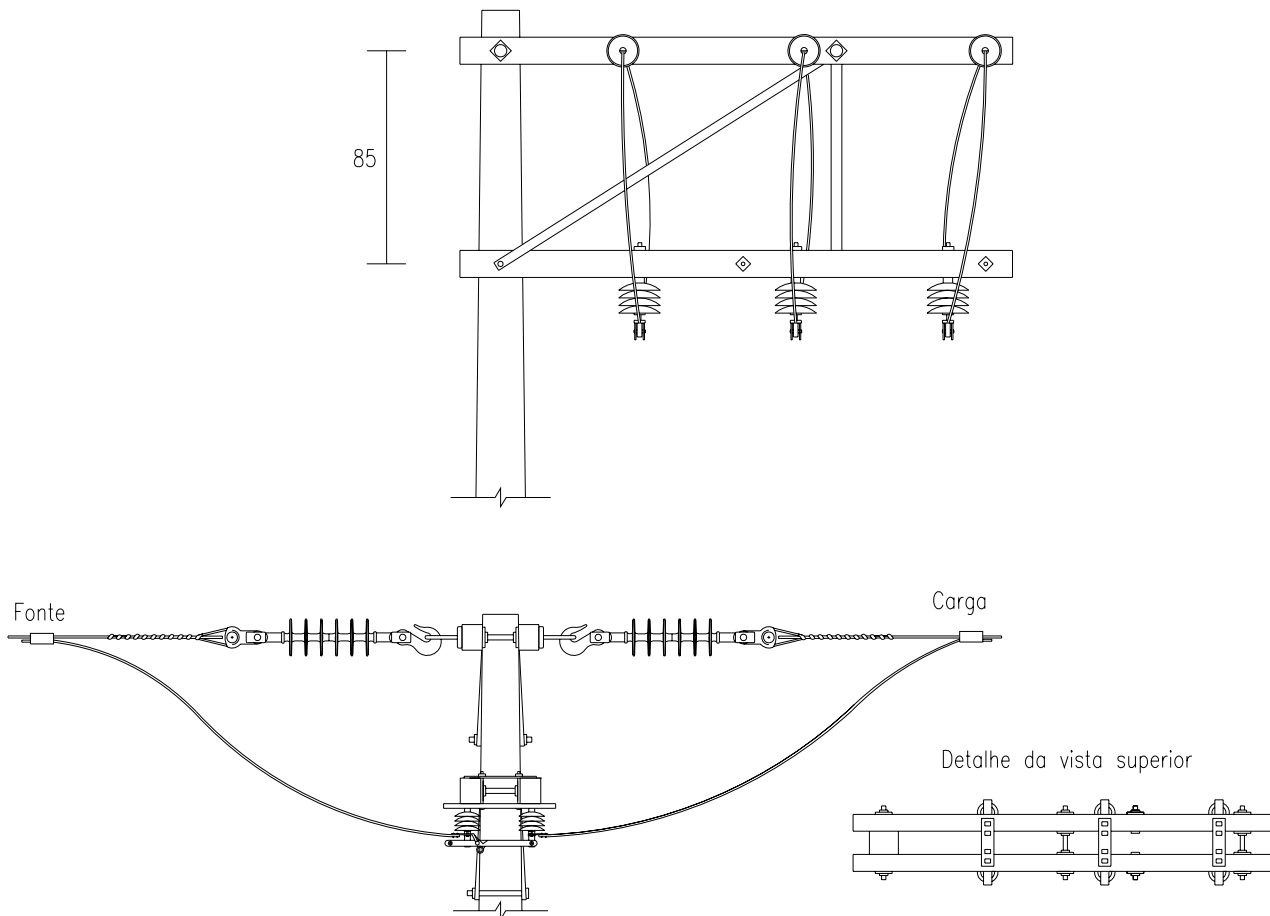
Estrutura B4 chave faca (manobra) (montagem alternativa)
